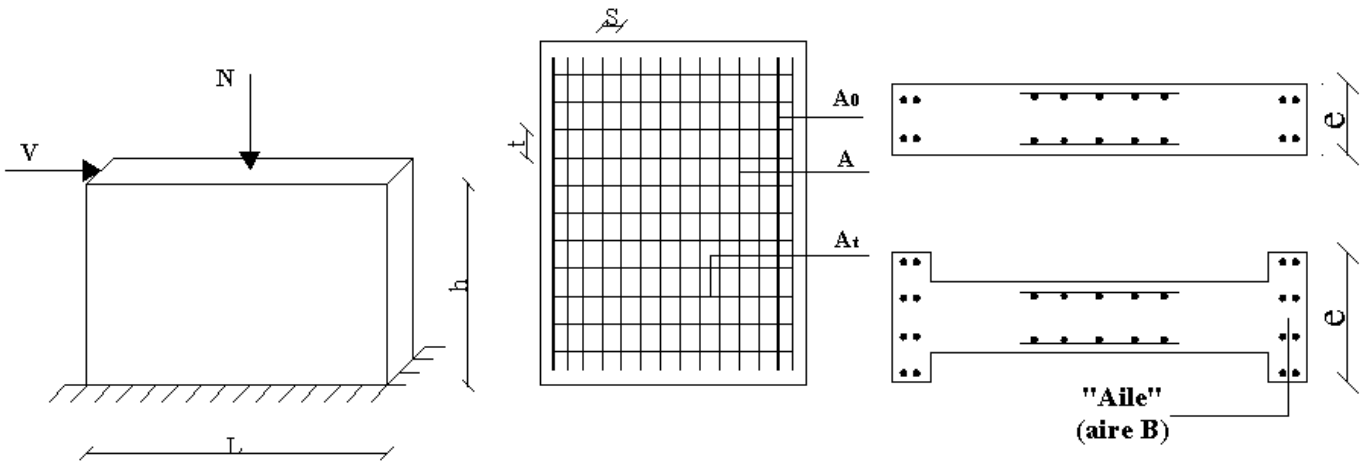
Disposition du ferrailage d'un voile et un schéma d'un voile plein.
